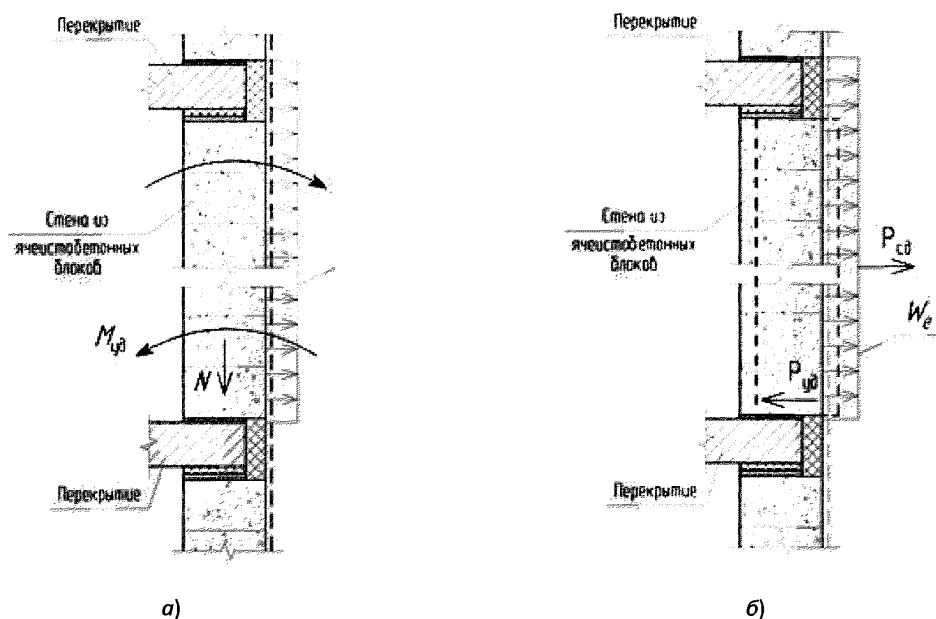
Расчетные схемы поэтажно опертой стены
